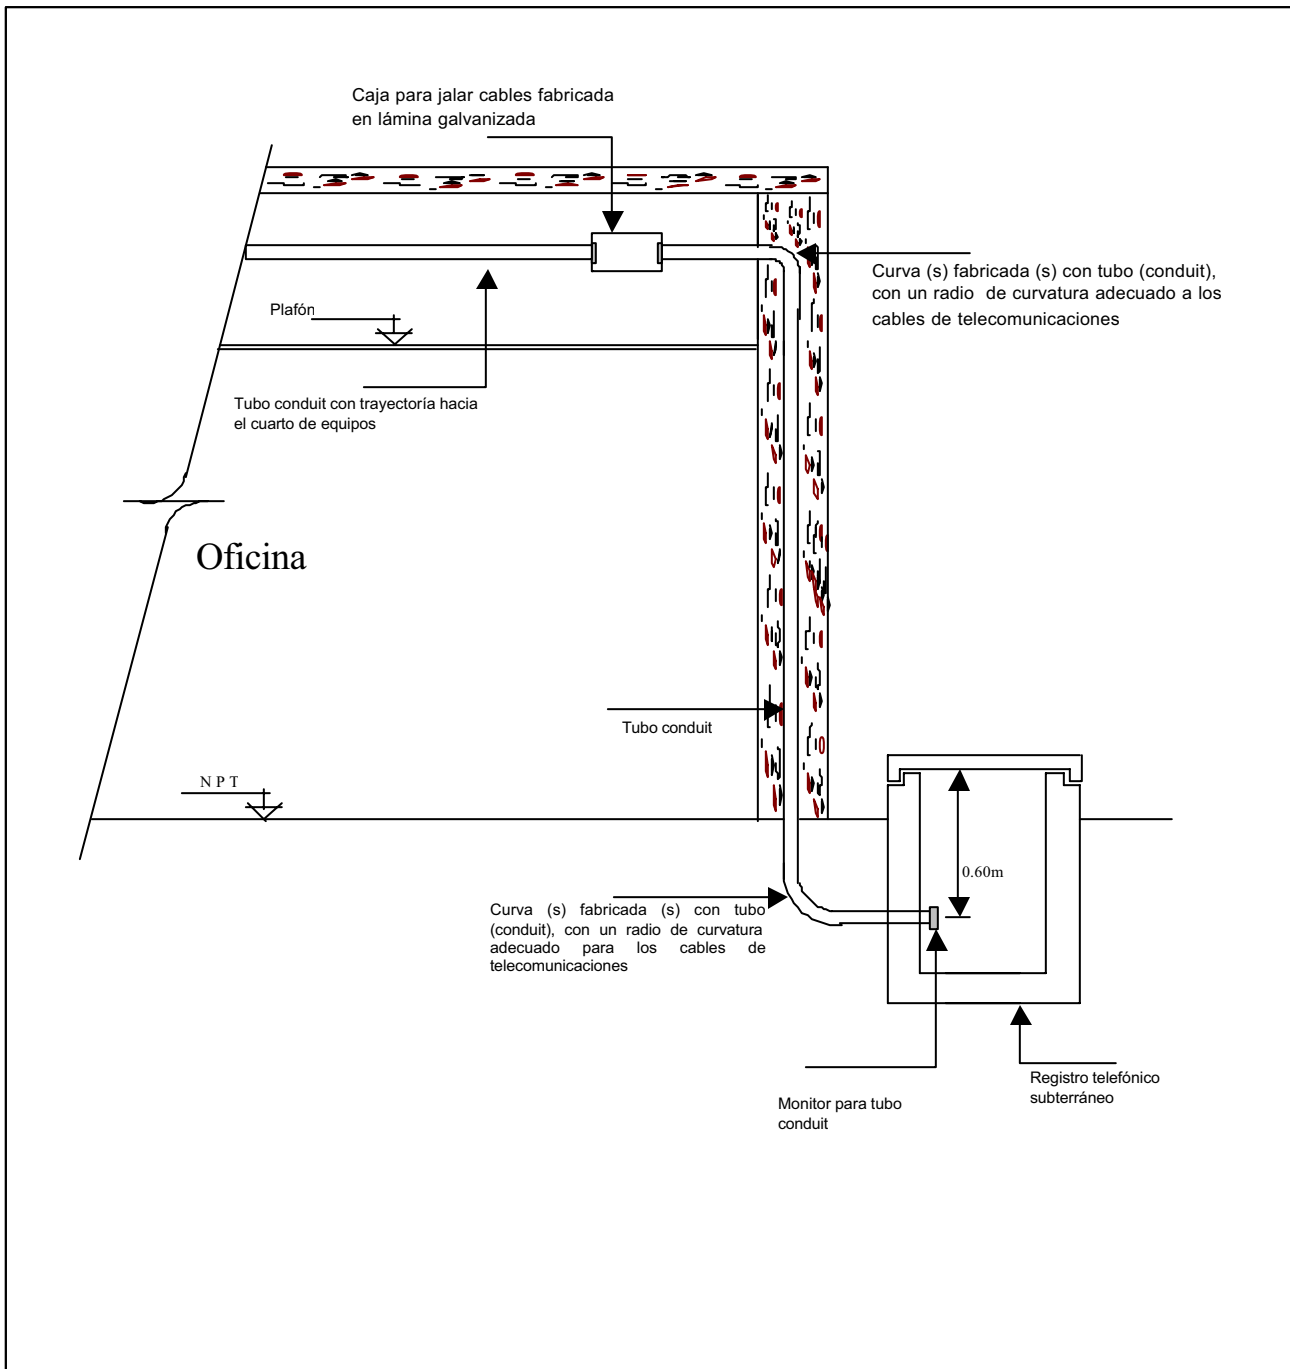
Detalle tipo A para acometida a edificio.
